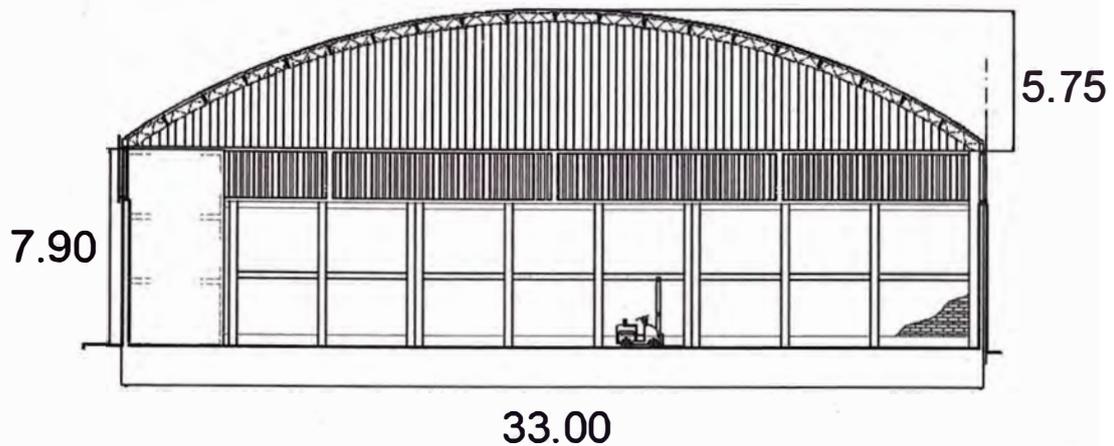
Elevación de una nave con el sistema convencional.
